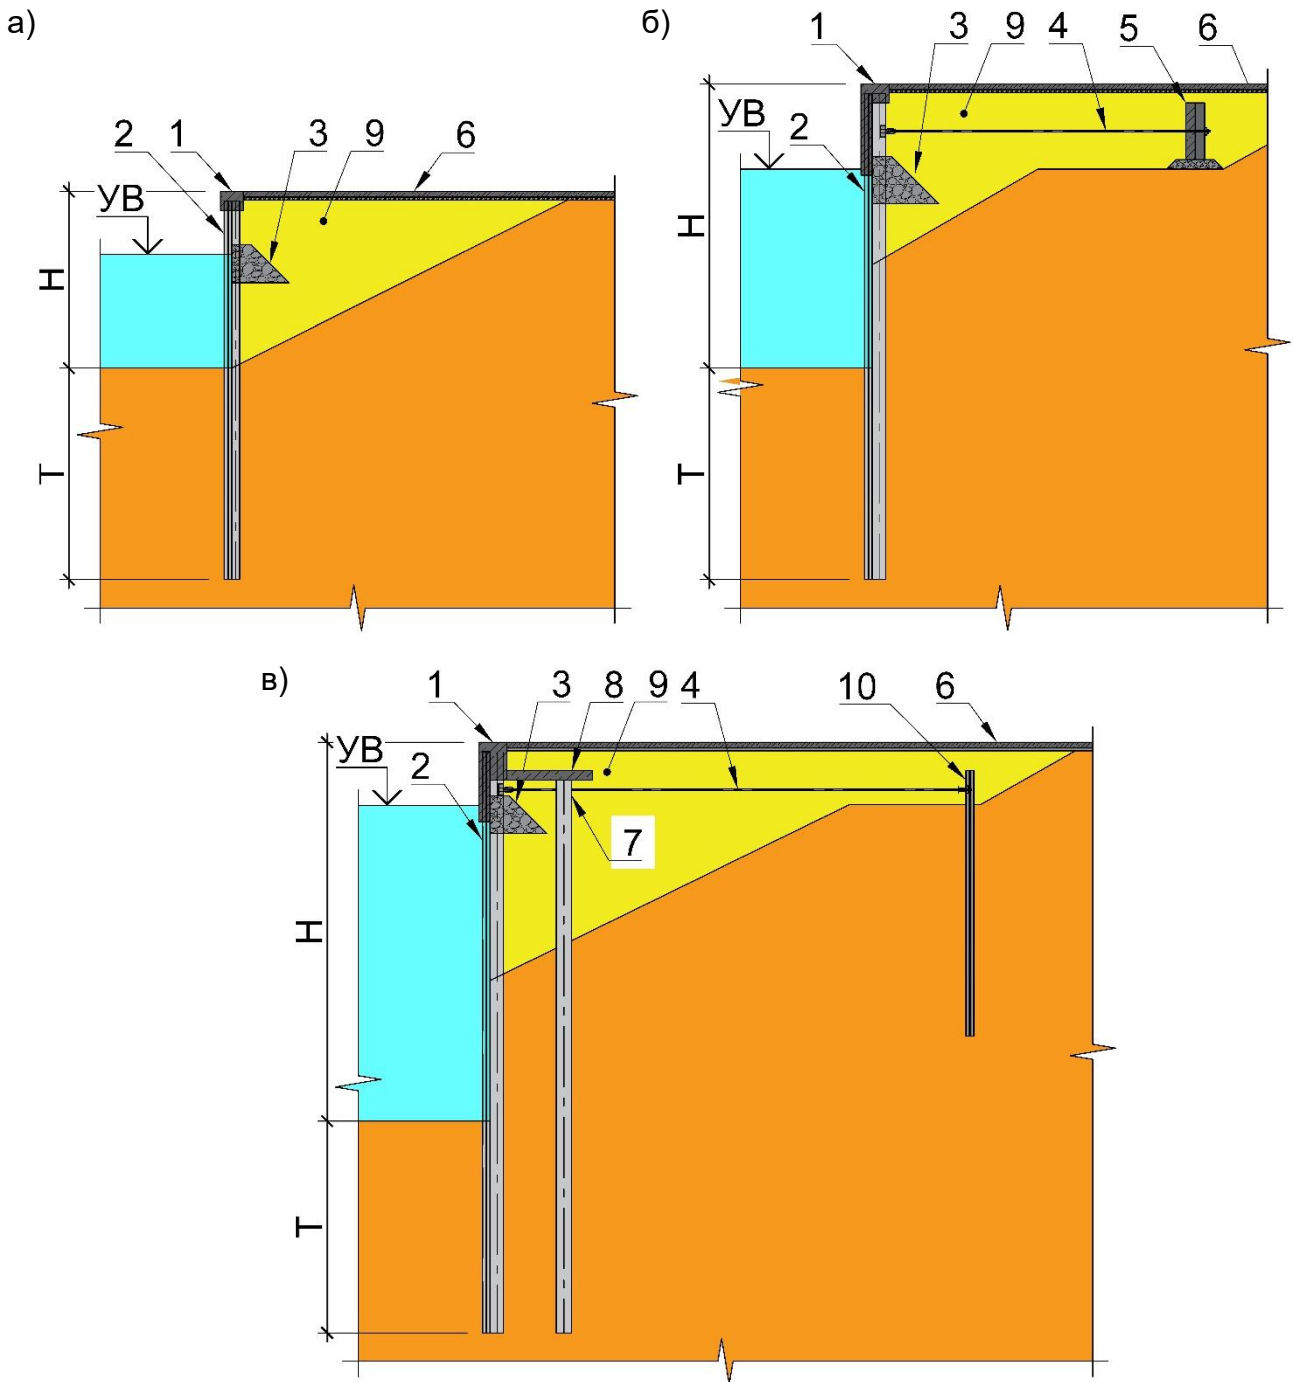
Причальные сооружения с применением БШС: Н – высота причальной стенки; Т – глубина погружения шпунта; а – шпунтовая стенка без анкерного крепления; б – шпунтовая стенка с анкерным креплением; в – экранированная шпунтовая стенка с анкерным креплением; 1 – шапочный брус; 2 – БШС; 3 – дренажная призма; 4 – анкерная тяга; 5 – анкерная плита; 6 – покрытие территории; 7 – экранирующая свая; 8 – разгрузочная плита; 9 – засыпка; 10 – анкерная стенка.
